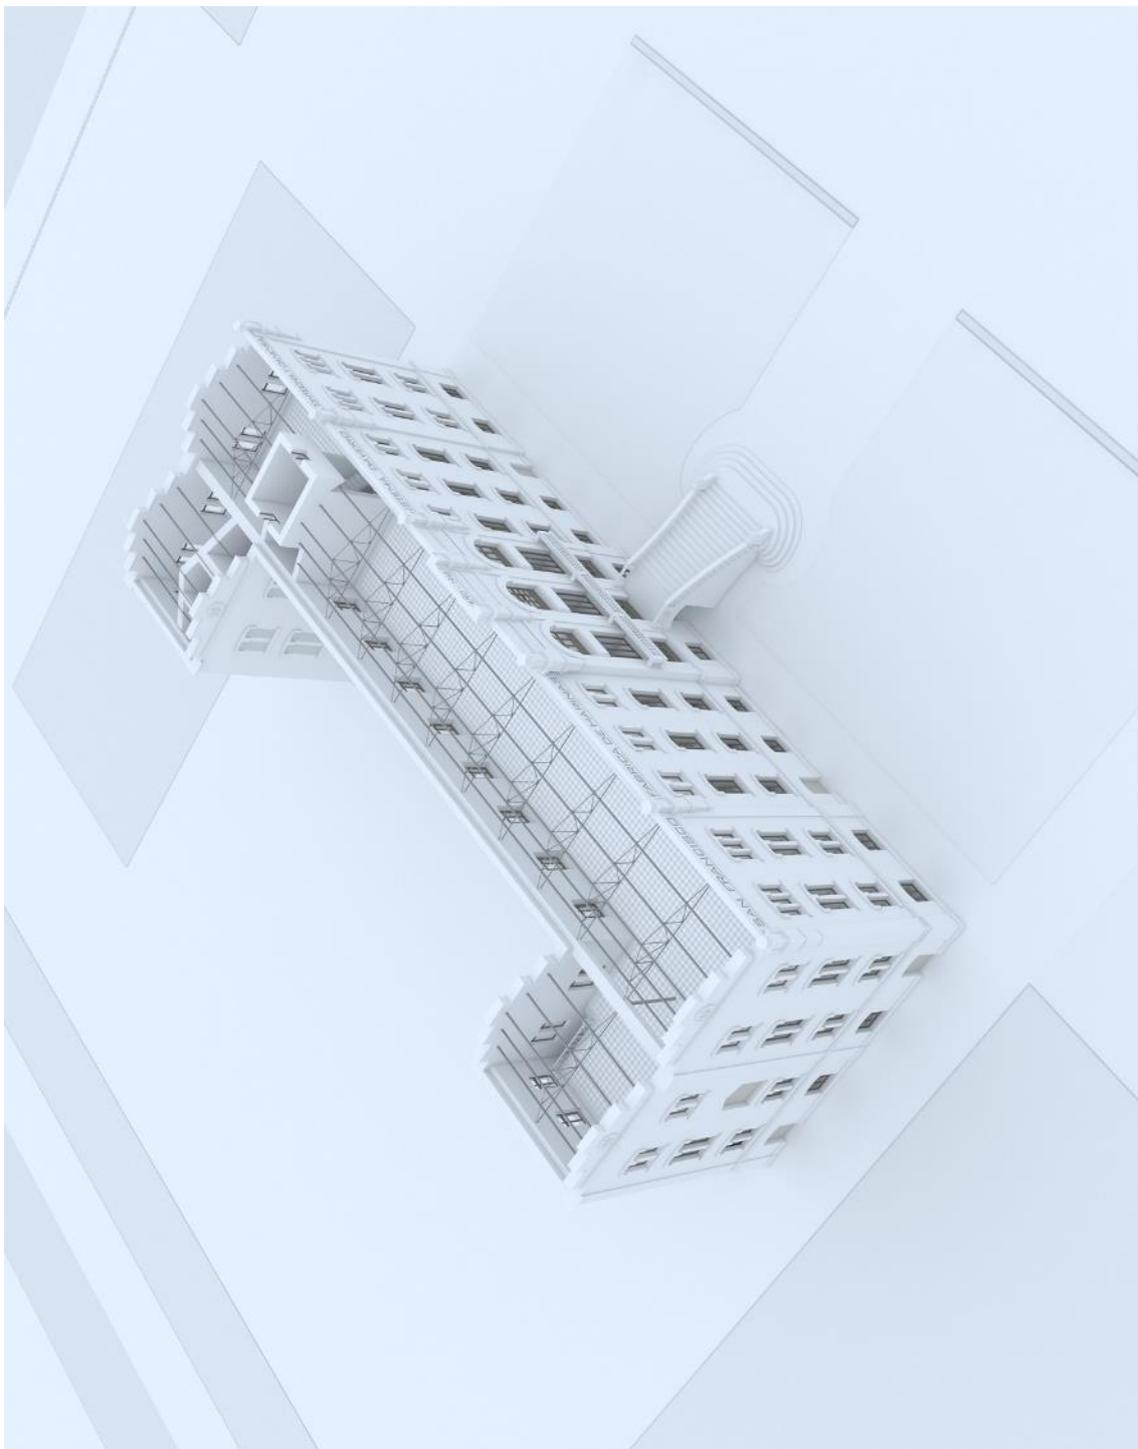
Imagen virtual. La fábrica. Planta tercera. Estructura de cubierta.
